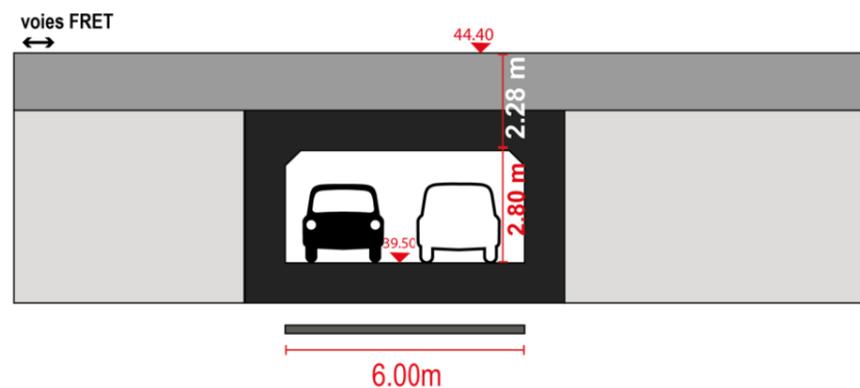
Coupe de principe sur l'ouvrage cadre (source : Egis)
